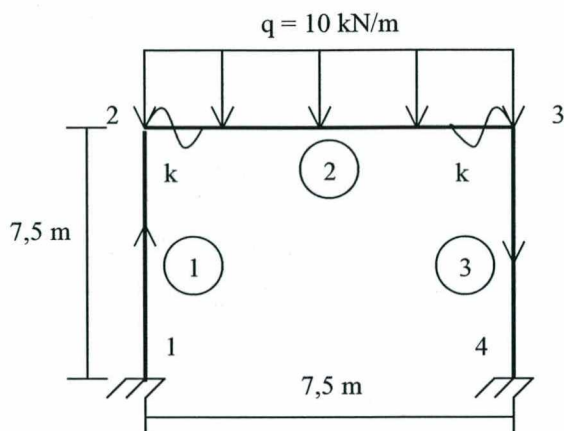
Pórtico plano com aplicação das “molas” somente na viga.
